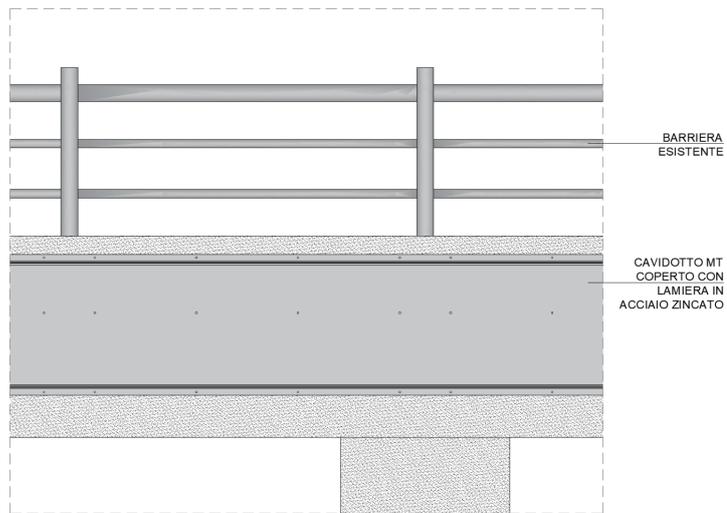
Particolare costruttivo tipo dell'attraversamento del ponte
